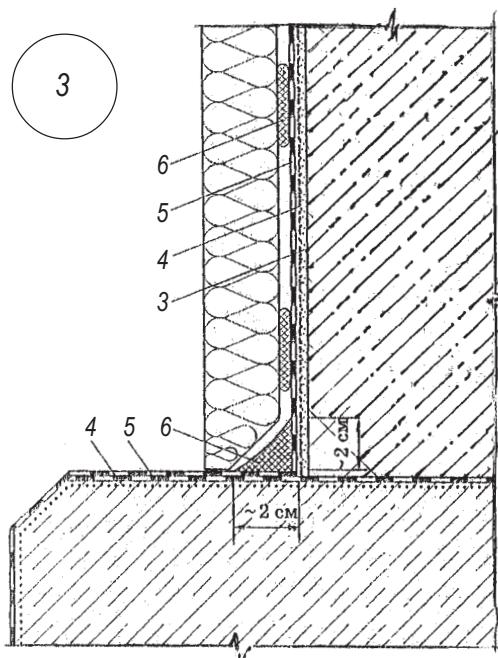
Стикування вертикальної гідроізоляції стіни та гідроізоляції фундаментної подушки:
